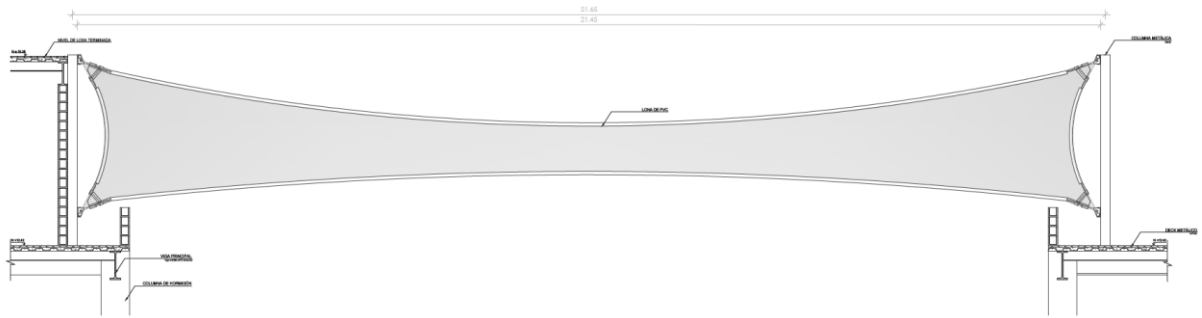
Corte de cubierta plegable. (Villegas, C. 2021).
